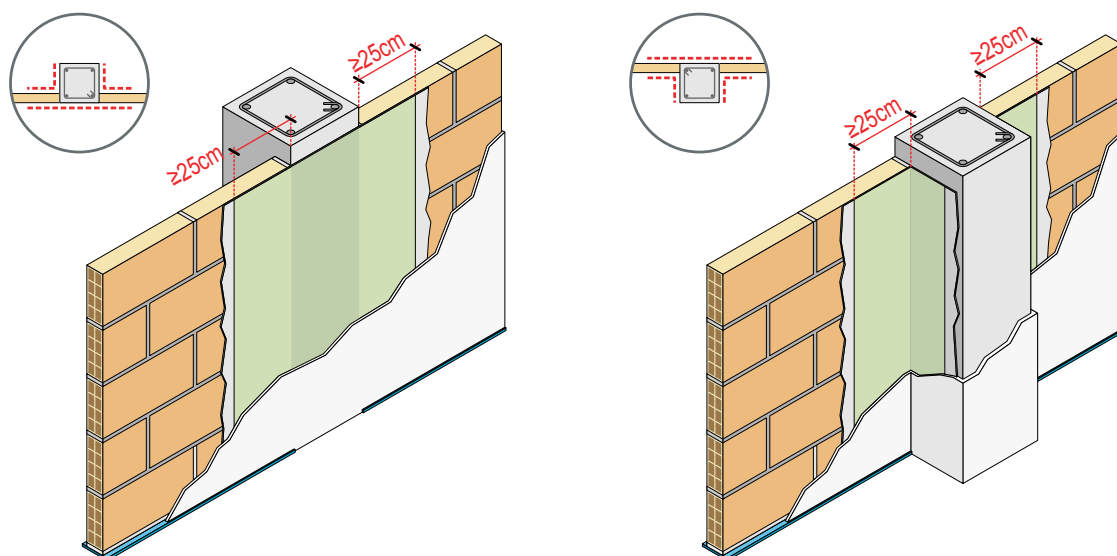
Encuentro de un tabique con un pilar sin cajeado. Colocación de las bandas de refuerzo.
